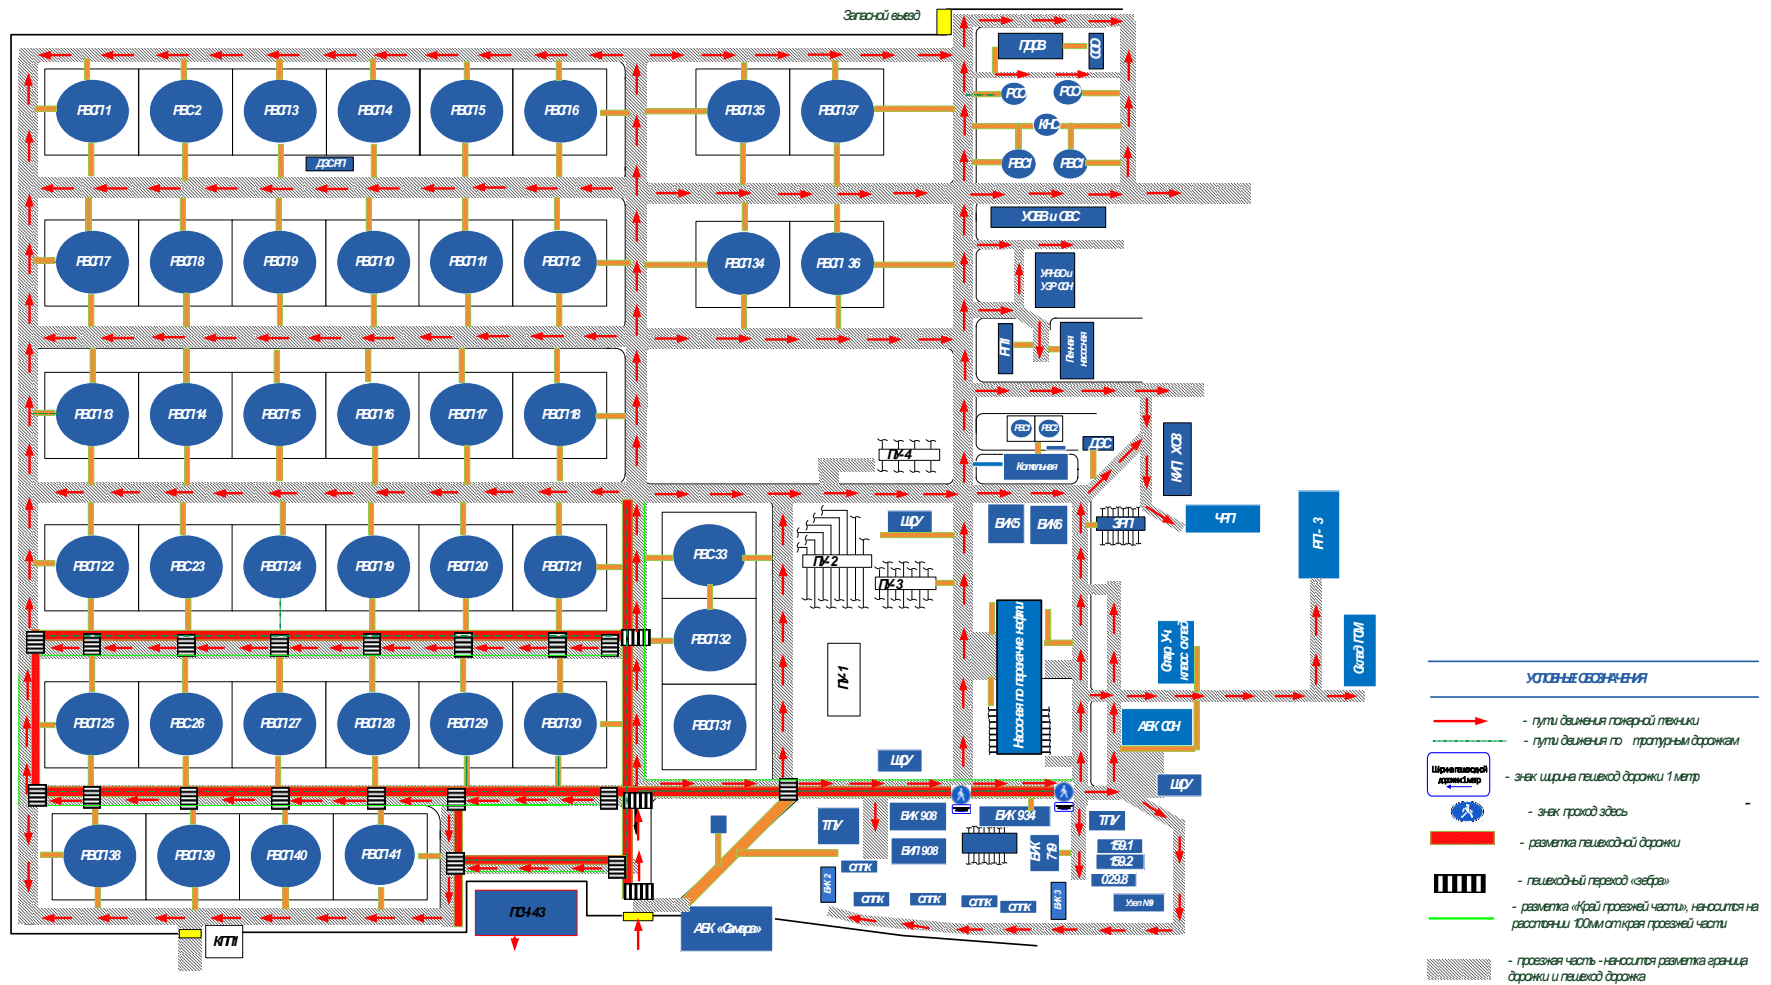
Схема генерального плана производственной площадки «Самара»
